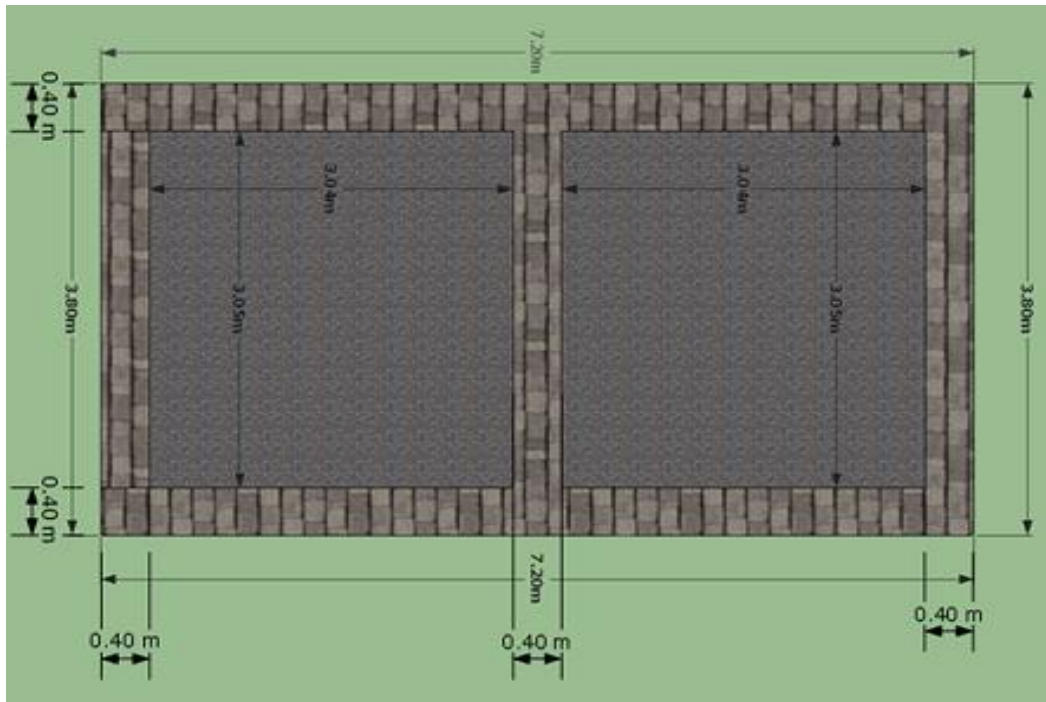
Imagen de la vista de planta en corte seccionado, más sus dimensiones correspondientes.
